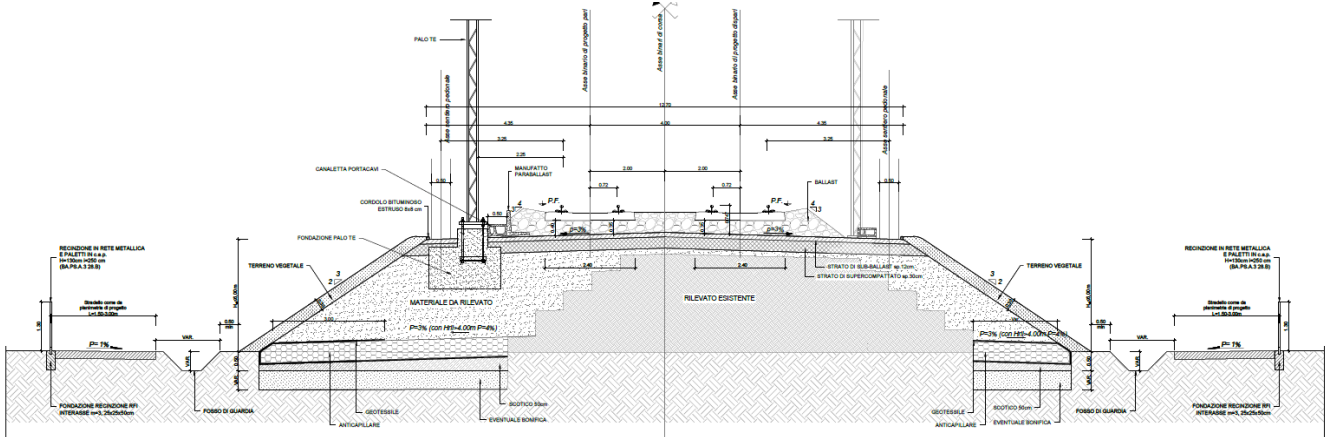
Sezione tipo di progetto in rilevato con raddoppio a 4.00m
